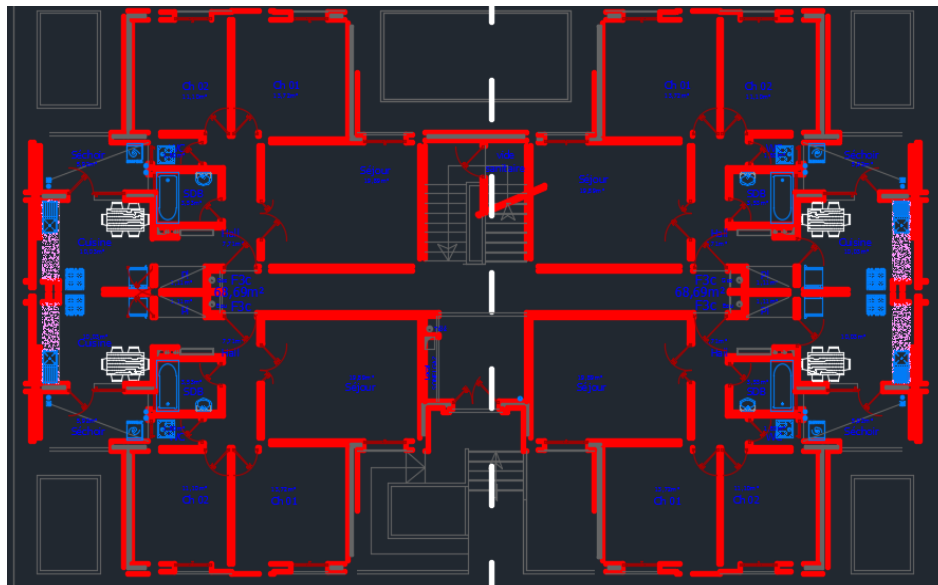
30: Plan RDC c'est un étage courant du bloc type B (R+5)
